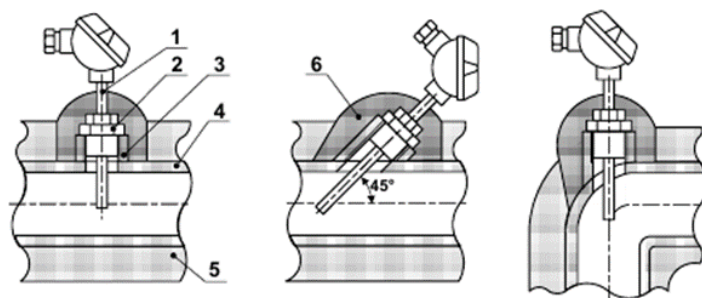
Варианты монтажа ТПС на трубопроводе. 1 – термопреобразователь сопротивления; 2 – защитная гильза; 3 – штуцер; 4 – трубопровод; 5 – теплоизоляция трубопровода; 6 – теплоизоляция ТПС
